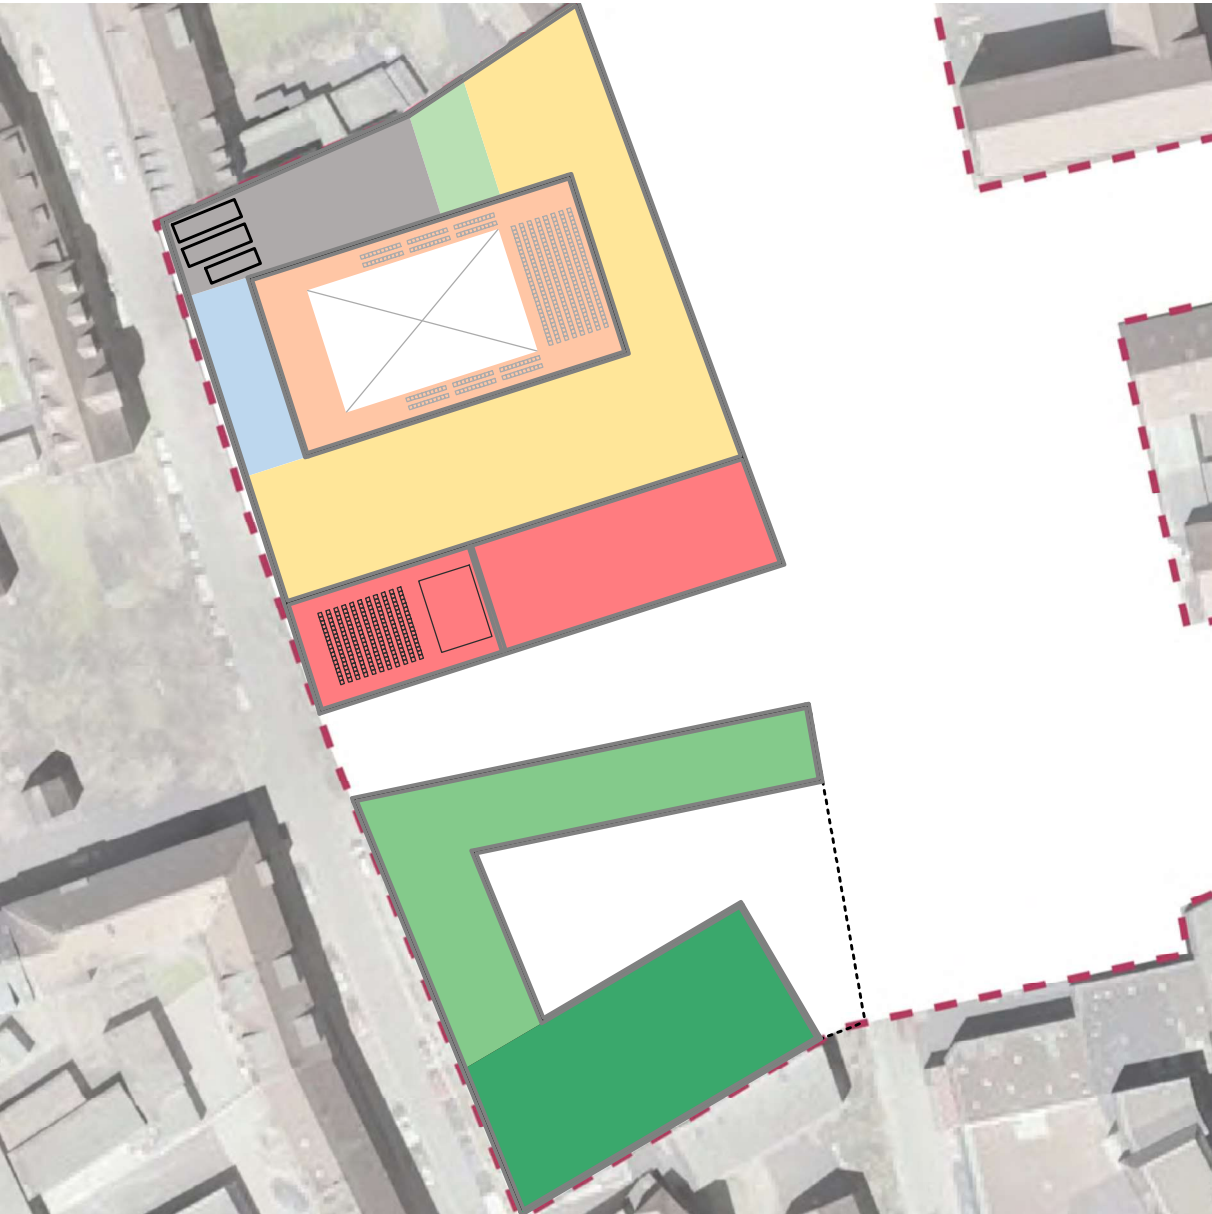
Grundriss EG Großer Hof V1
